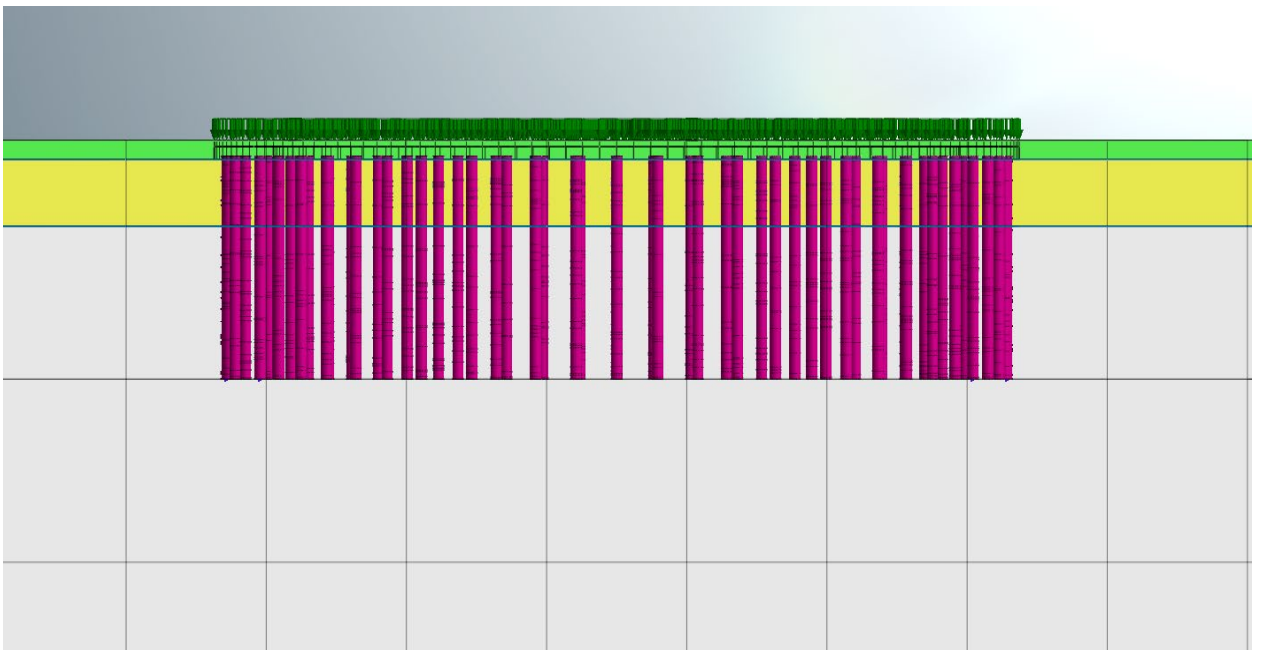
Схема посадки пространственной модели на инженерно-геологический разрез строительной площадки
